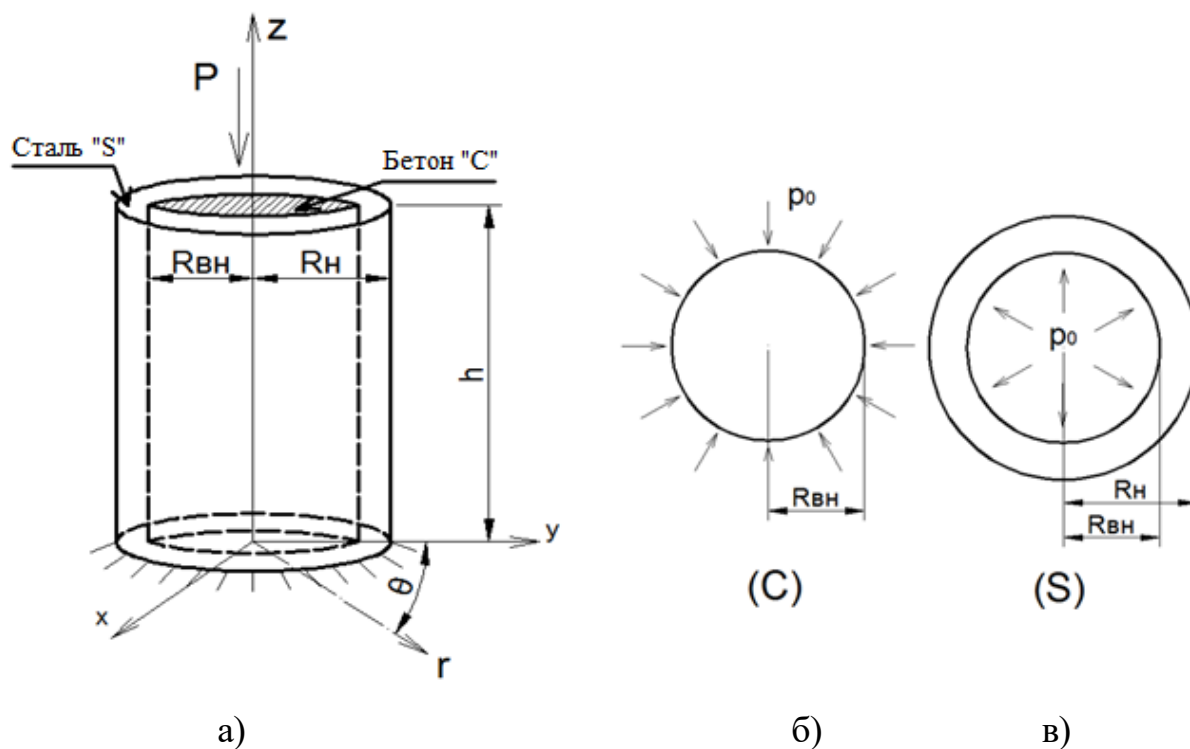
Расчетная схема трубобетонной стойки:
